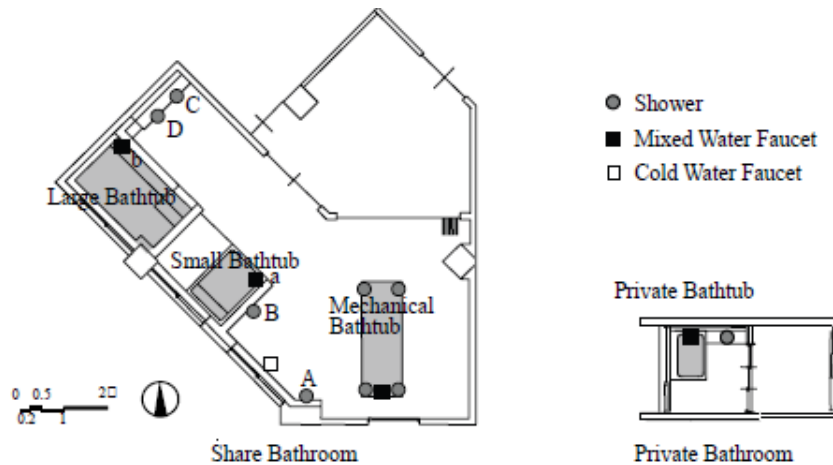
Planta das instalações sanitárias (Takaaze *et al.*, 2007).
